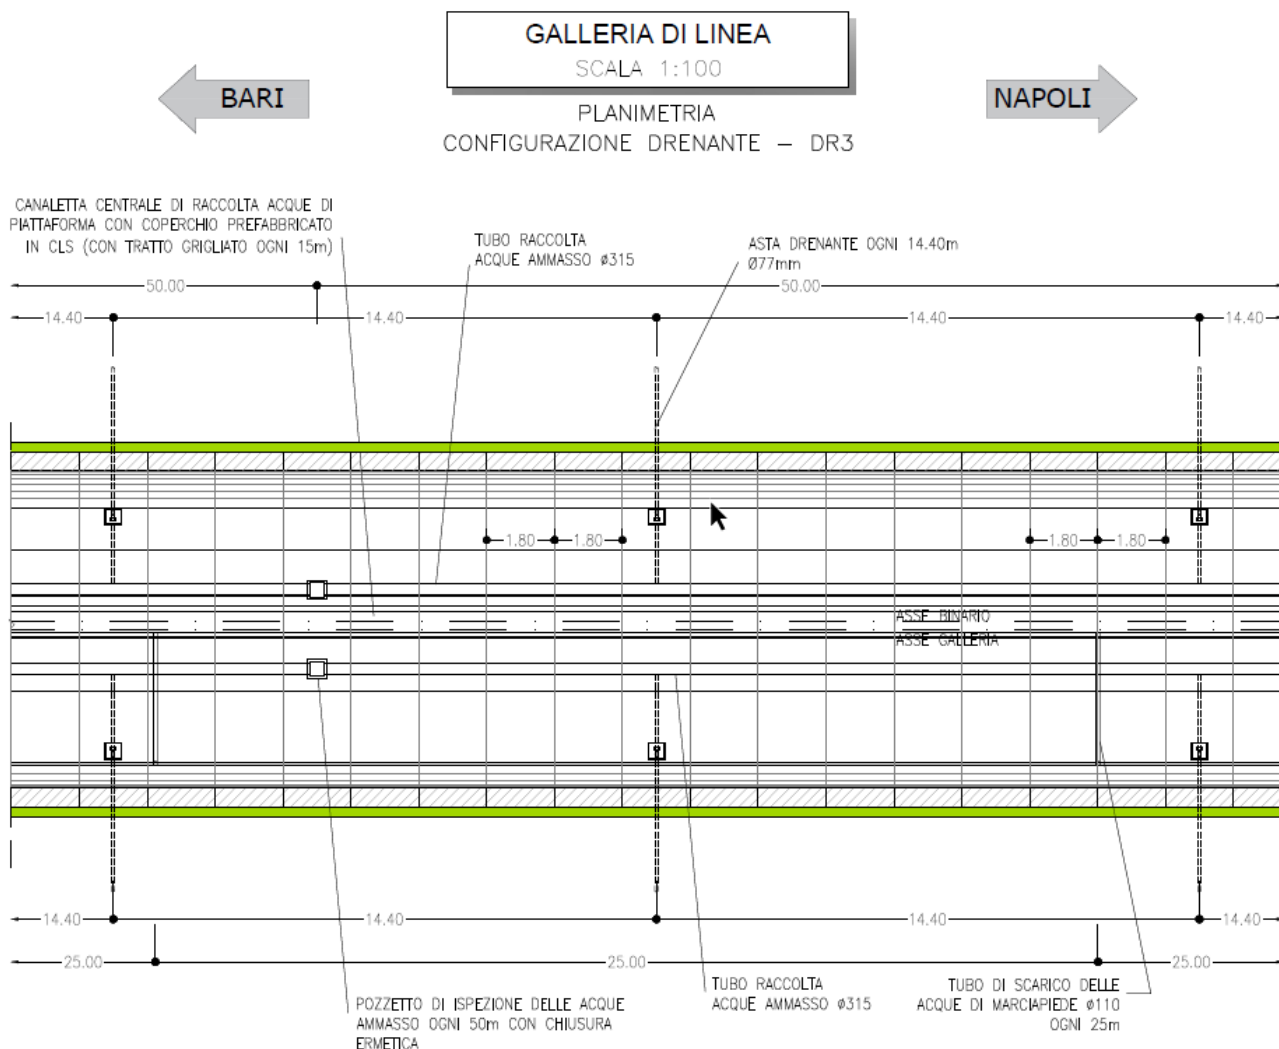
Sistema di drenaggio acque d'ammasso – DR3 (planimetria)
